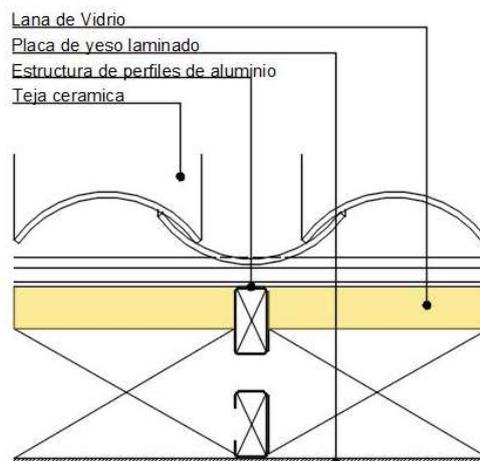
Detalle de cubierta con aislamiento. Sección transversal.
